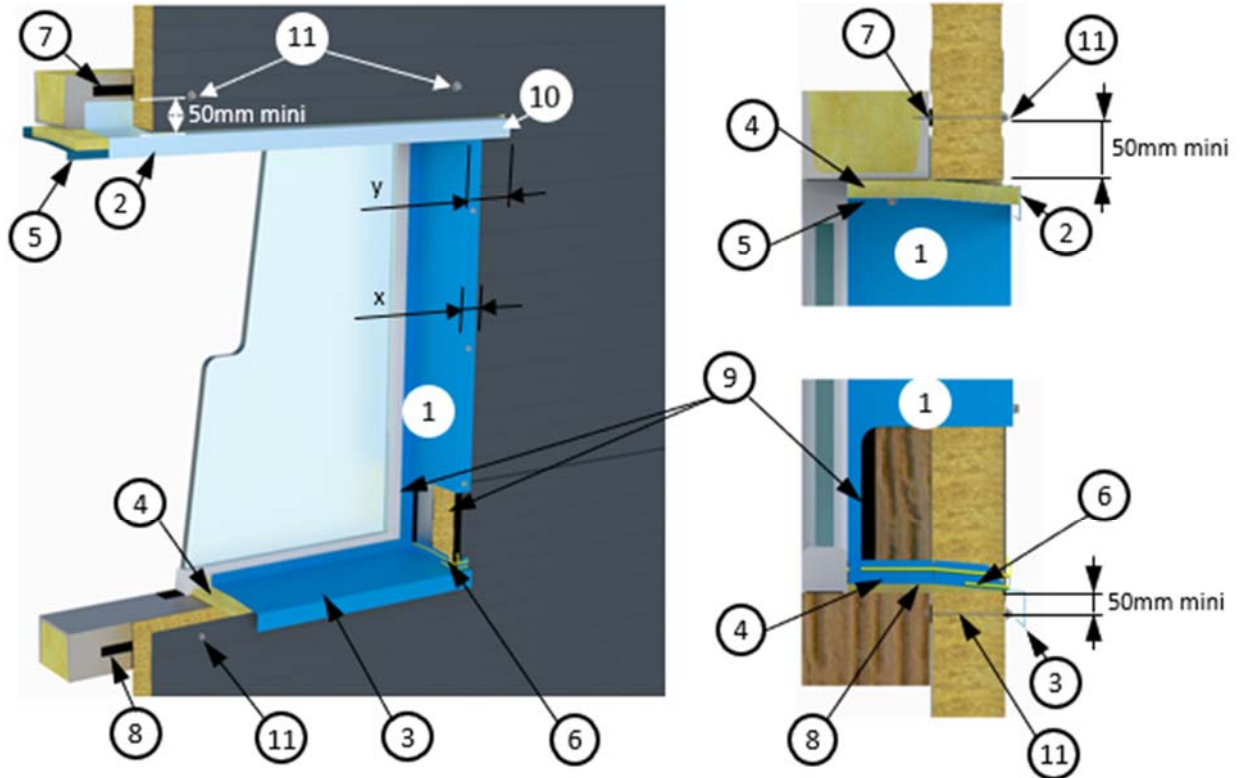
Ouverture – Pose verticale (limité à une hauteur de bâtiment de 20 mm)
